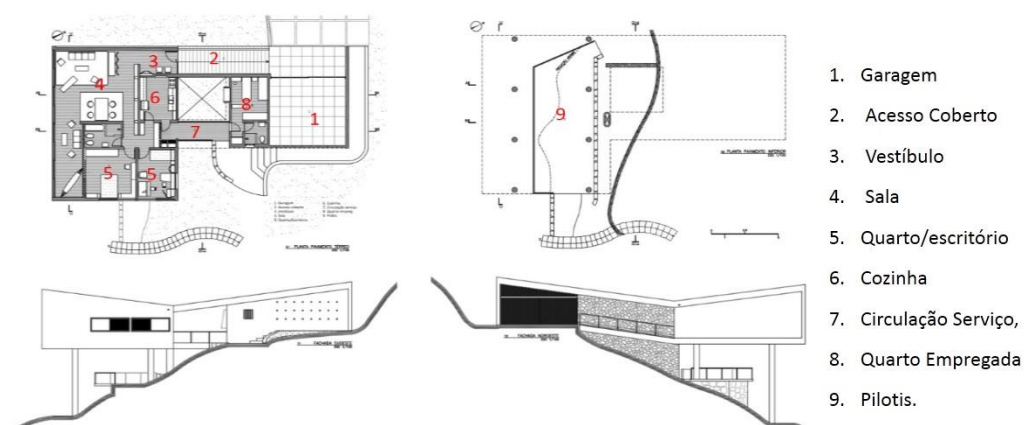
Fachadas e Planta baixa pavimento térreo e inferior da Casa Carmen Portinho. (Afonso Reidy, Jacarepaguá – RJ, 1952). Fonte: http://www.casasbrasileiras.arq.br/plantas/1-100_6-PORTINHO_A4.pdf
